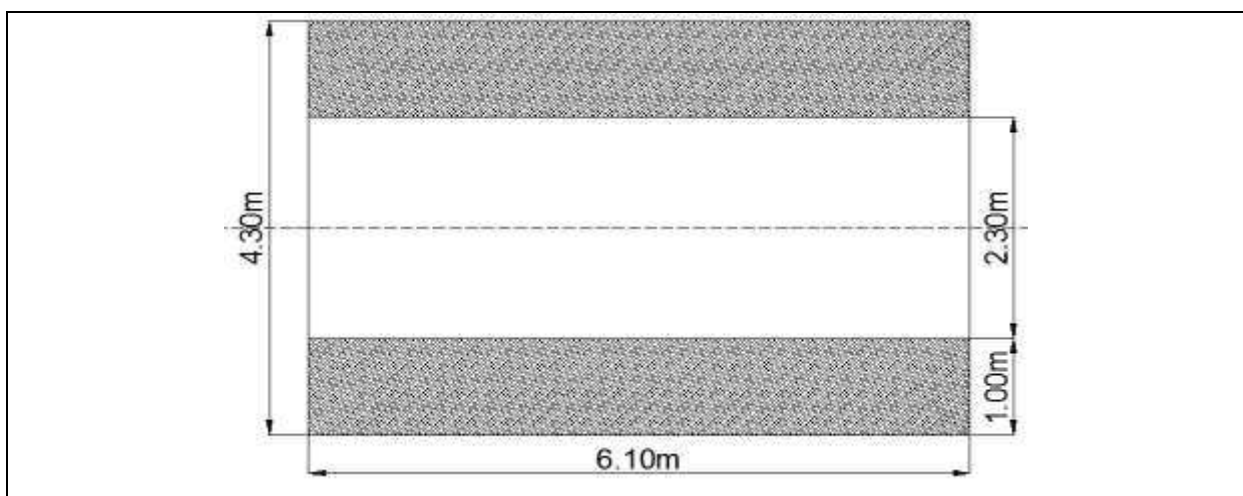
Vue en plan des chenilles du sous-système MC120
